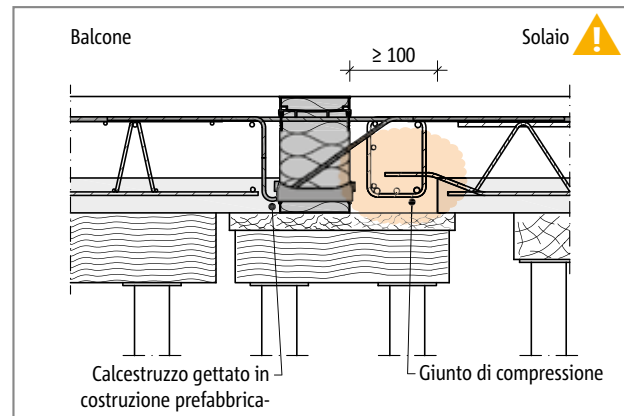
Schöck Isokorb® tipo KXT: appoggio indiretto, montaggio con piastre prefabbricate (qui: $h \leq 200$ mm), giunto di compressione lato solaio
